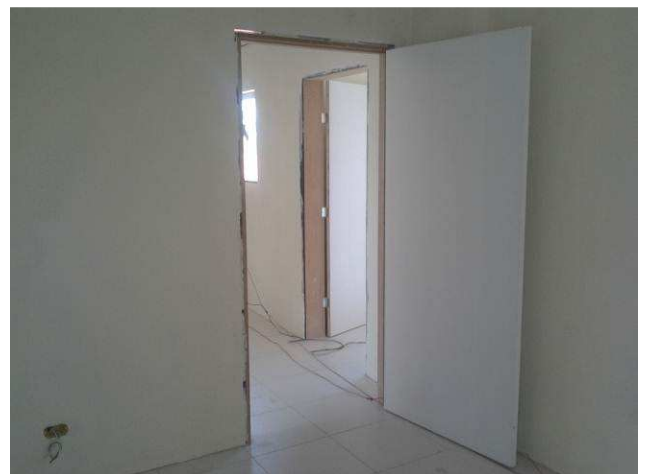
C: Portas de 90x210 instaladas no segundo pavimento
